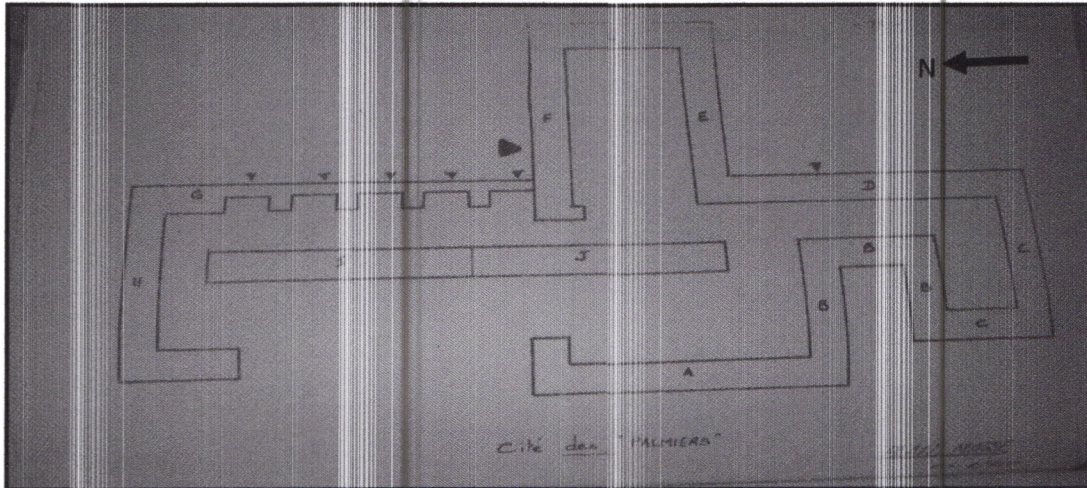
plan de masse de figure09 : plan de masse la cité les palmiers
